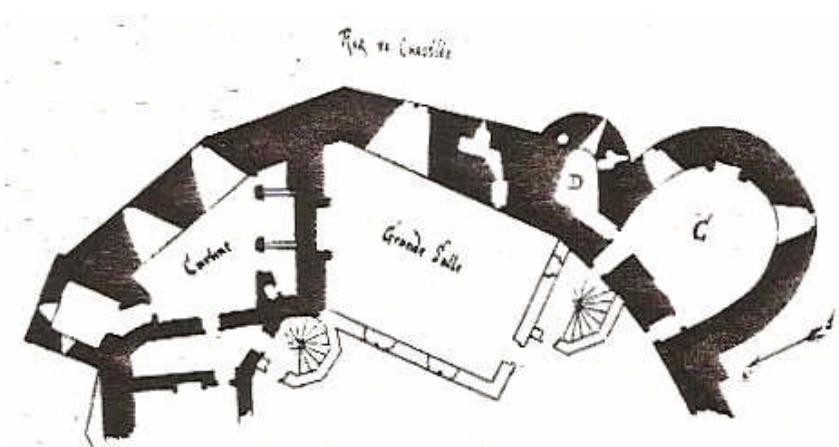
Plan des tours C D et du rez-de-chaussée du logis seigneurial et de la tour h
